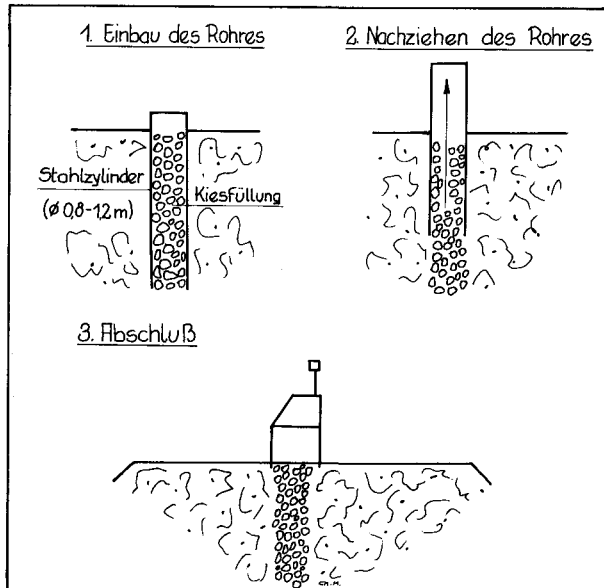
Schottersäule (und deren Anbringung) zur Entgasung (nach LAGA 6, 1983).
